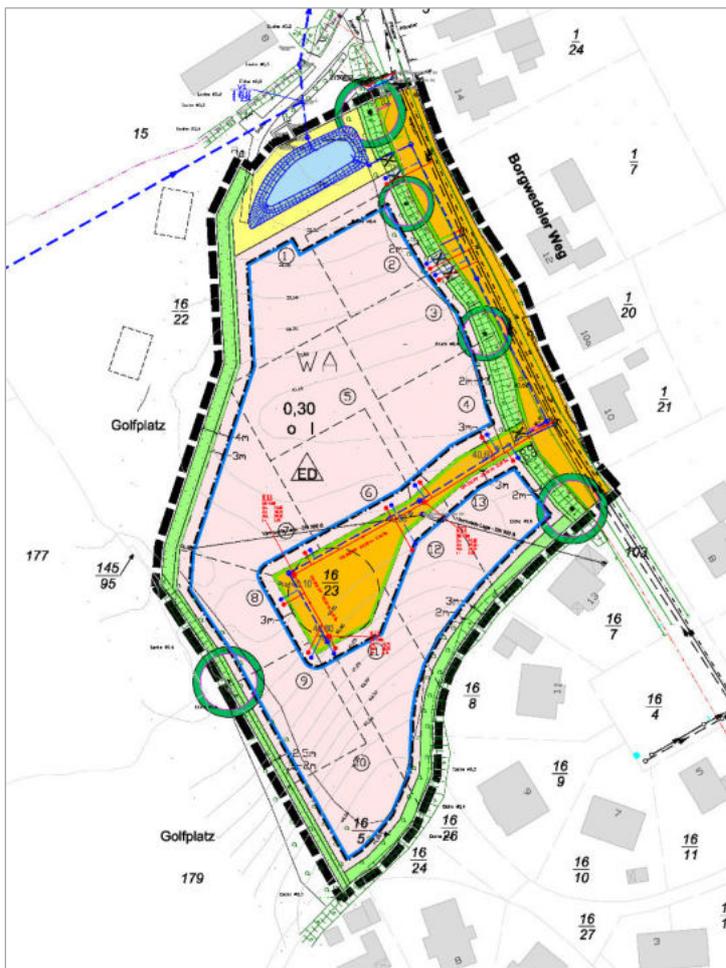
Lageplan B-Plan (siehe Anlage 3)
